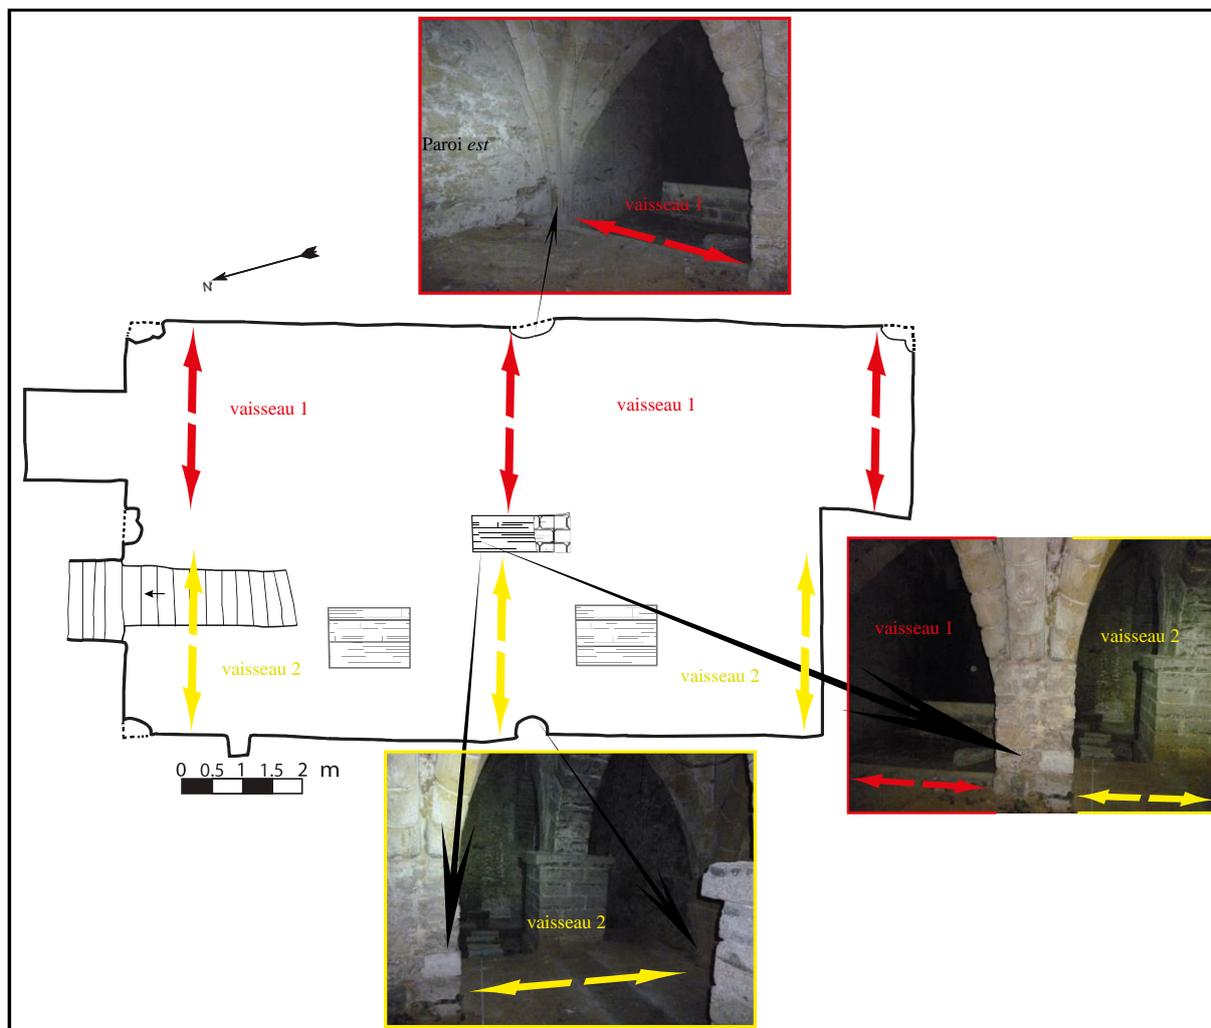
Illustration d'une cave de plan rectangulaire simple divisée, en élévation, en deux vaisseaux
